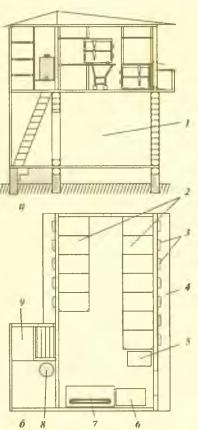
Схема павитьопа: а— вид сбоку; б— вид сверху; 1— баня; 2— ульи; 3— прилетные доски; 4— баткон; 5— передвижной ящик; 6— передвижная подставка; 7— рабочий стол; 8— медогонка; 9— стелнаж для ящиков с рамками
